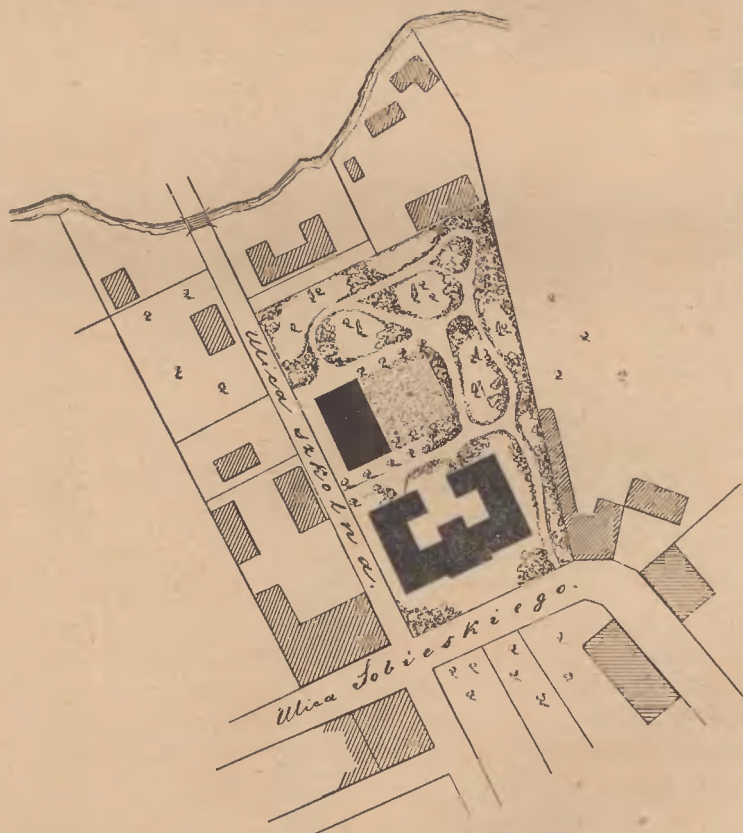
Plan sytuacyjny. (Situationsplan.)
